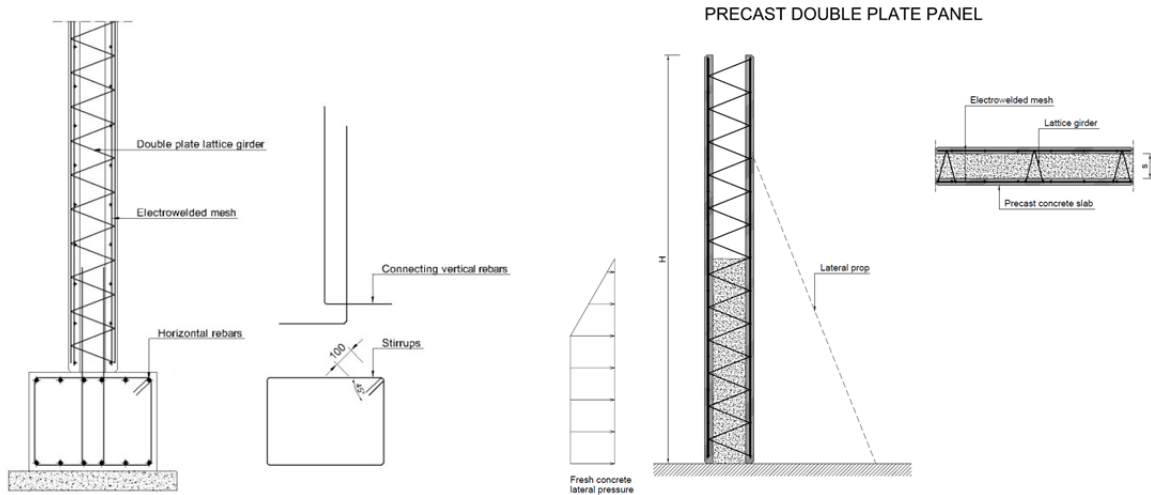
Exemple de détail structurel pour connexion entre mur BA et fondation (coupe verticale).
